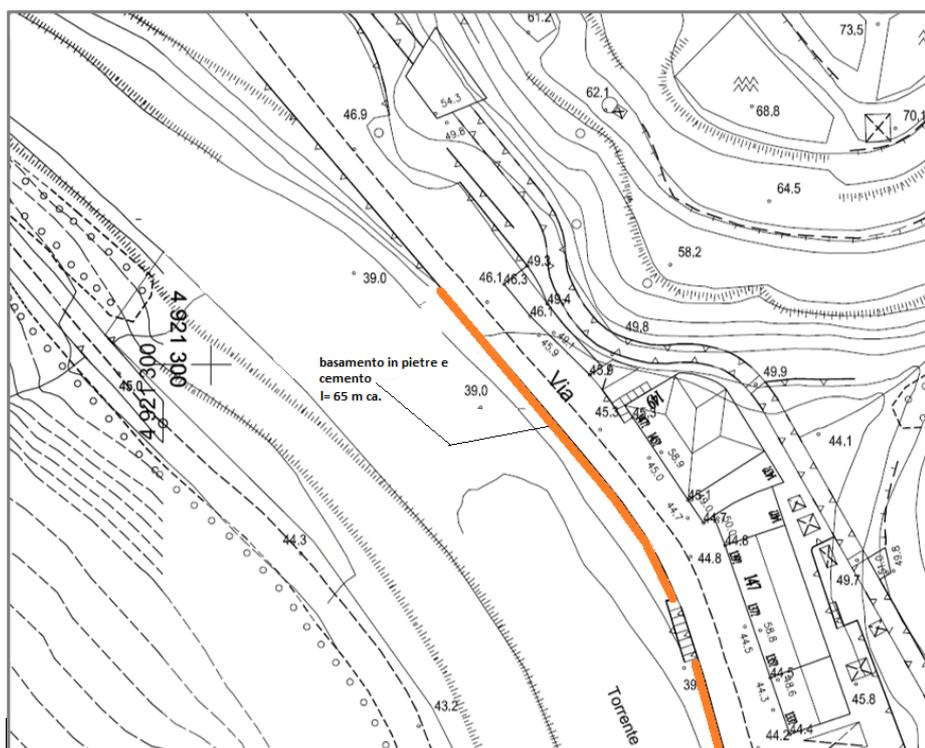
\_Estensione dell'opera a progetto sulla planimetria
